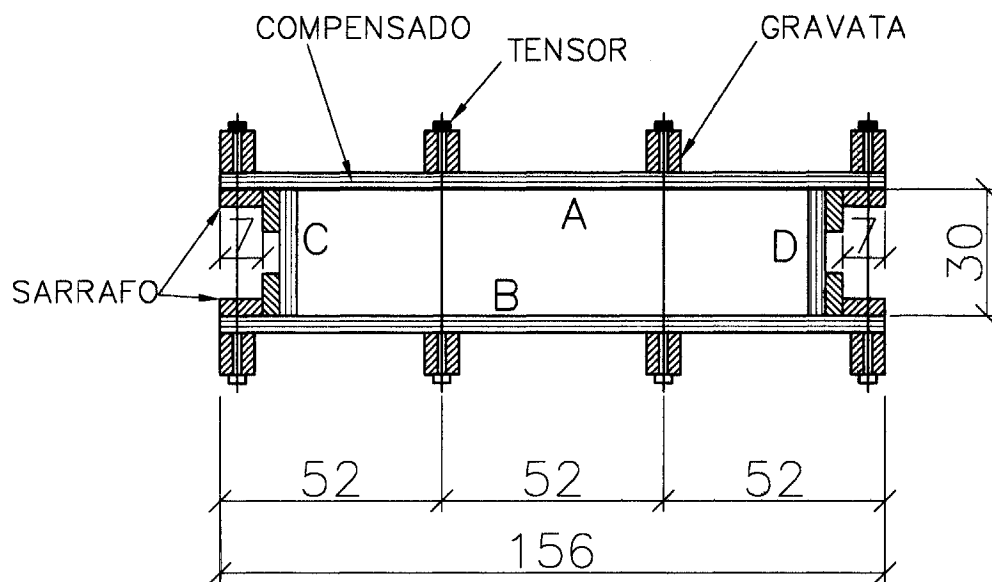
Detalhe da planta dos painéis de pilar (medidas em cm).
